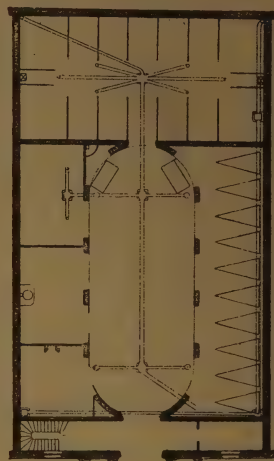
Communs, avenue Kléber à Paris; plan du rez-de-chaussée.
